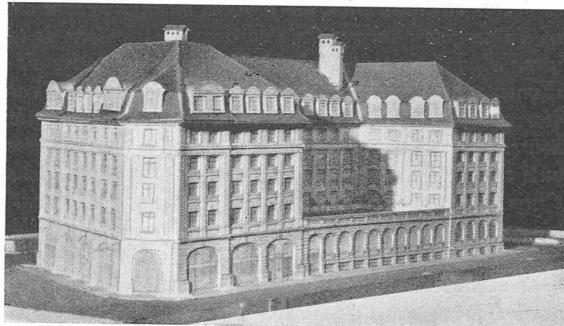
Reconstruction du mas situé entre les Terreaux du Temple et la rue des Corps-Saints (point A du plan général).
